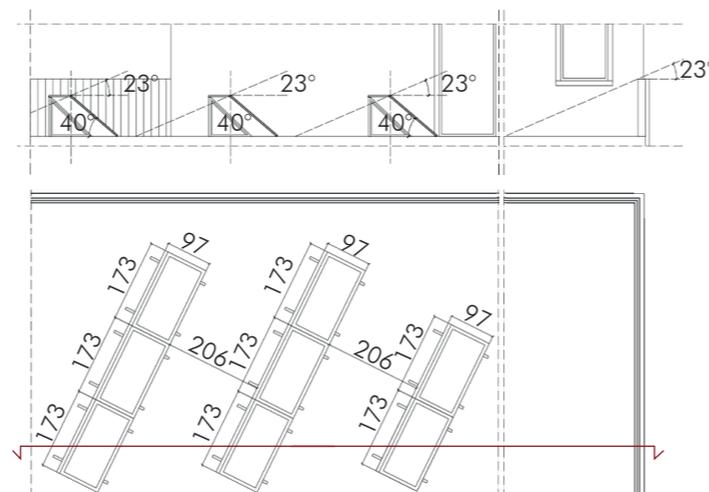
Pianta e sezione di una porzione della copertura, con indicate le distanze e gli orientamenti dei pannelli, elaborazione delle autrici
